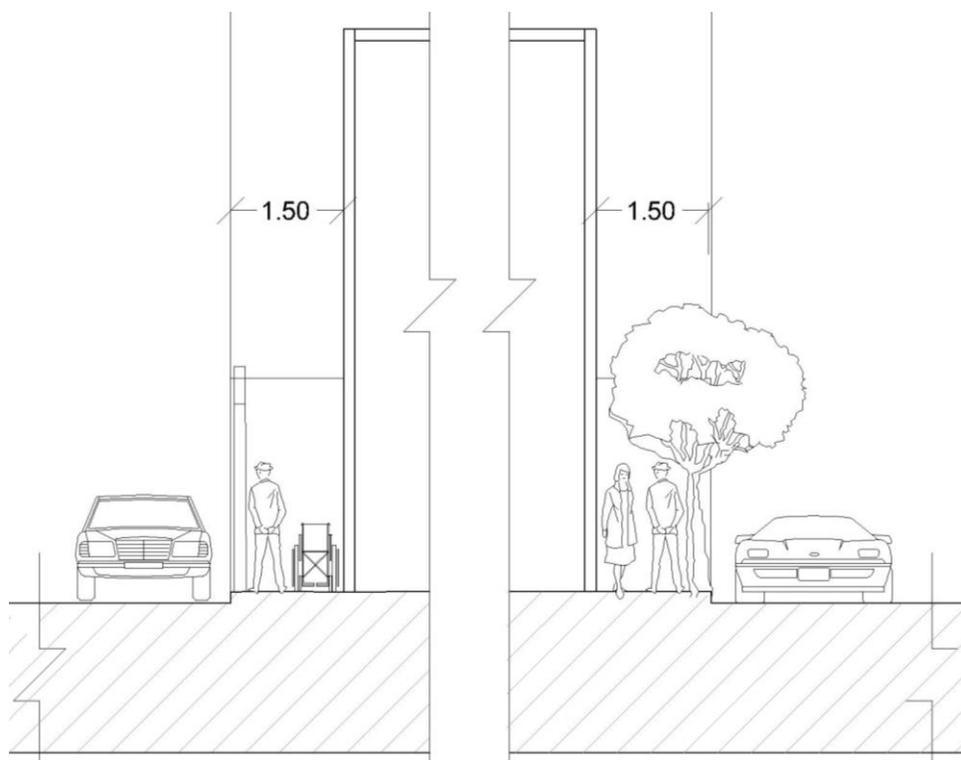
Corte esquemático con banquetas de 1.50 m de ancho, opción elegida para desarrollarse en el proyecto. Fuente: elaboración propia.
